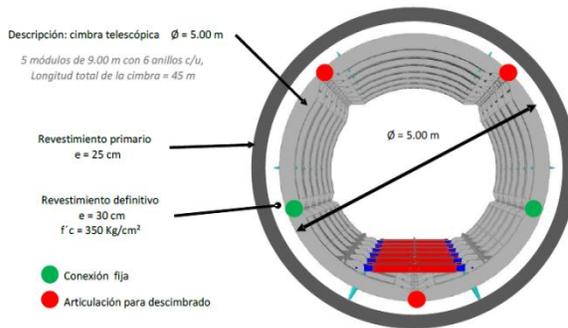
Sección frontal de cimbra telescópica. Detalle de conexiones.
